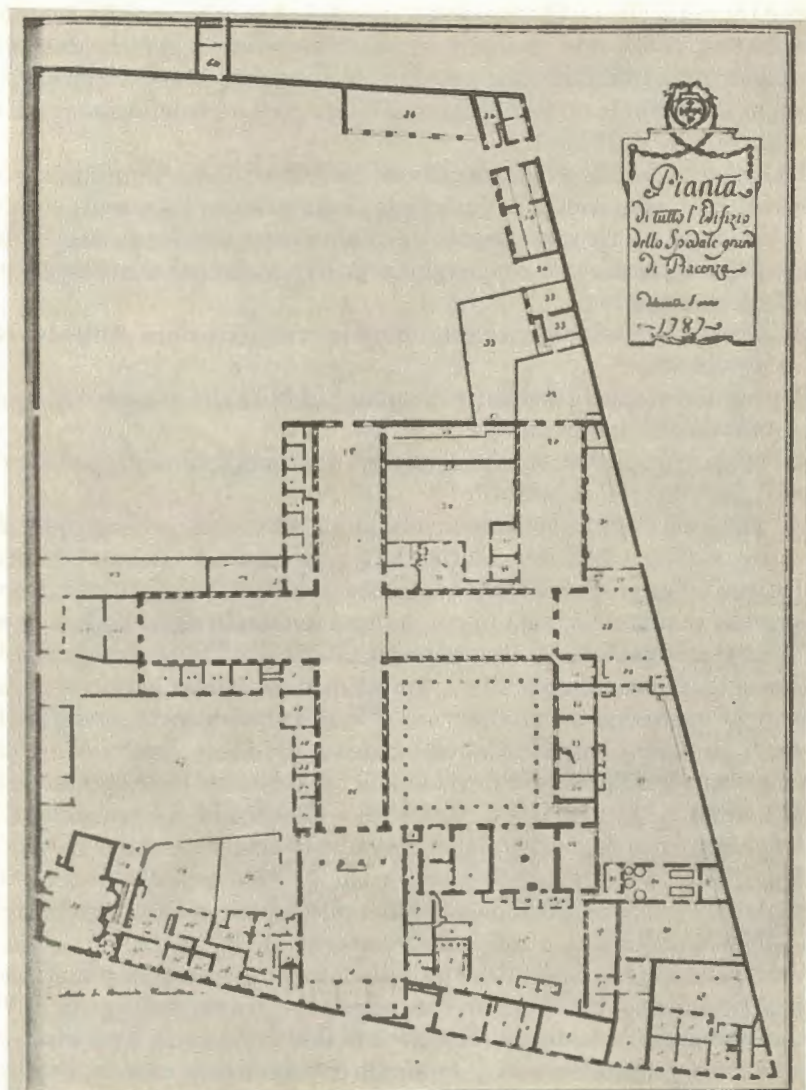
Archivio dell'Ospedale di Piacenza, Pianta del 1787
